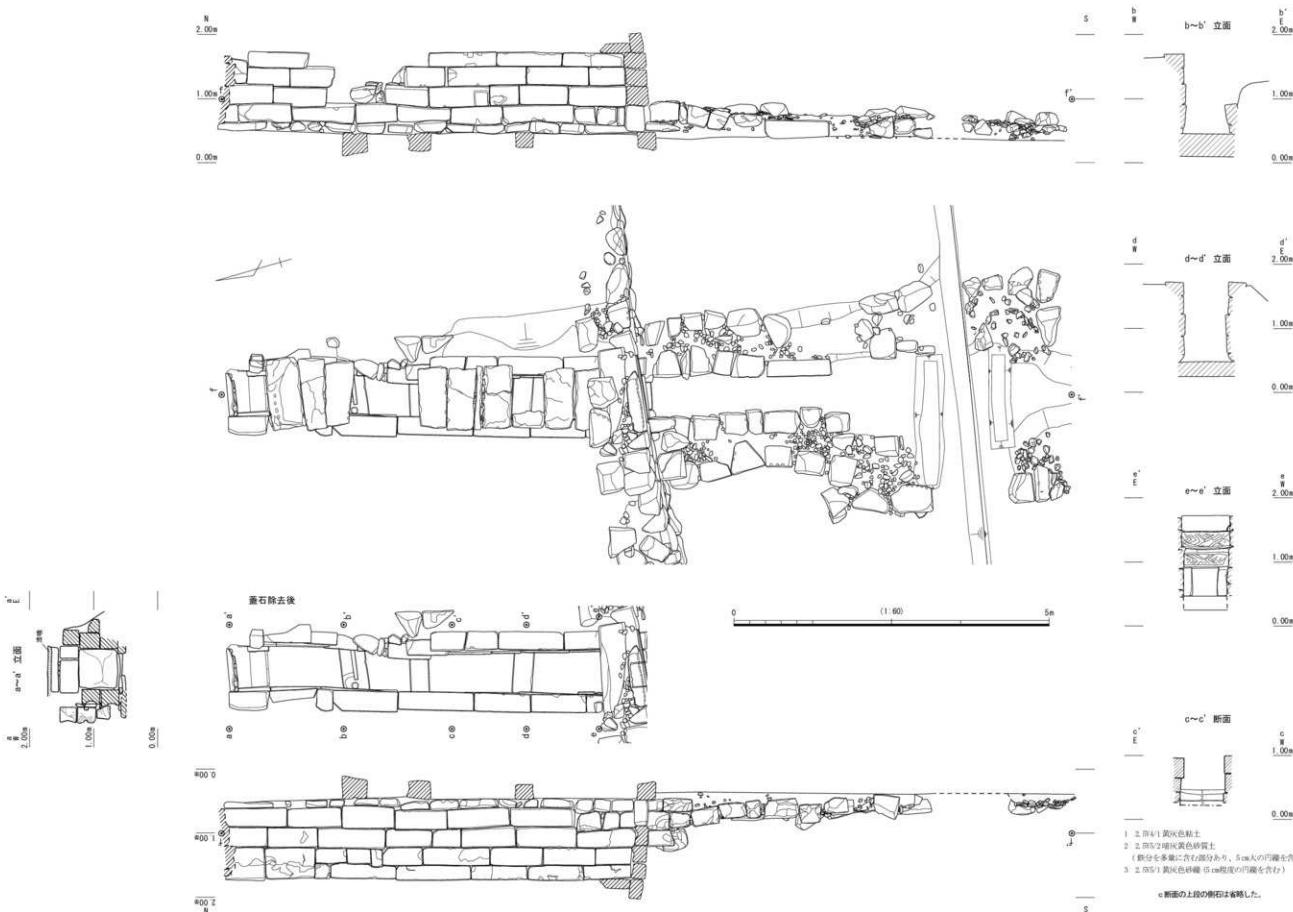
溝水路A・配石構造 平面図・断面図・立面図 (1/60)
